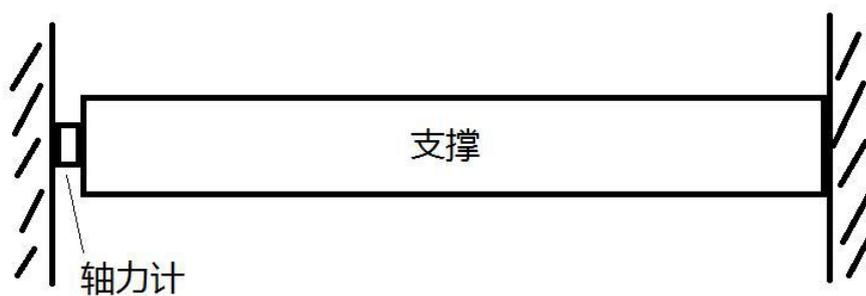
钢支撑轴力监测轴力计布置示意图
